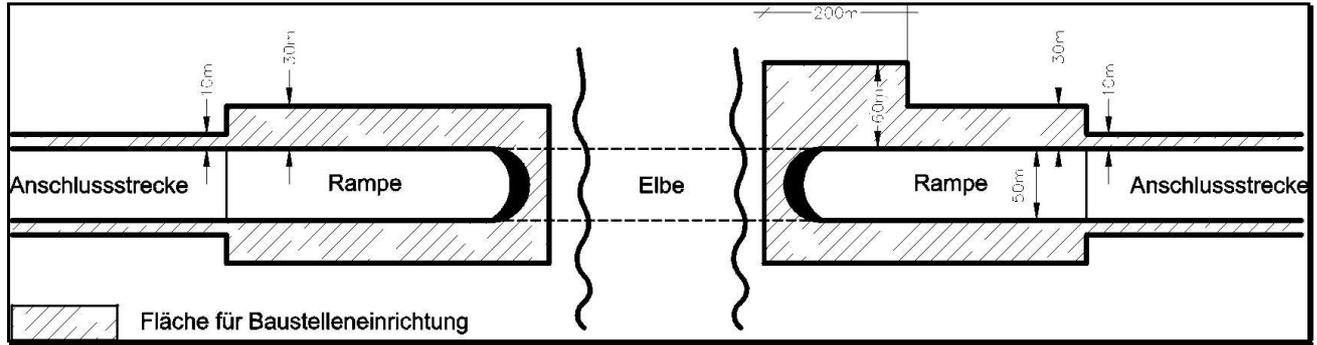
Baustelleneinrichtungsflächen für den Elbtunnel
